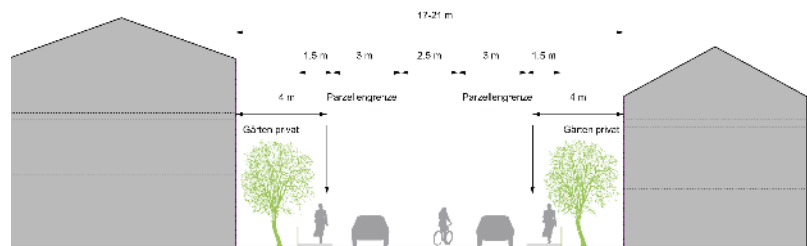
Schemaschnitt Winznauerstrasse, Abschnitt 2
